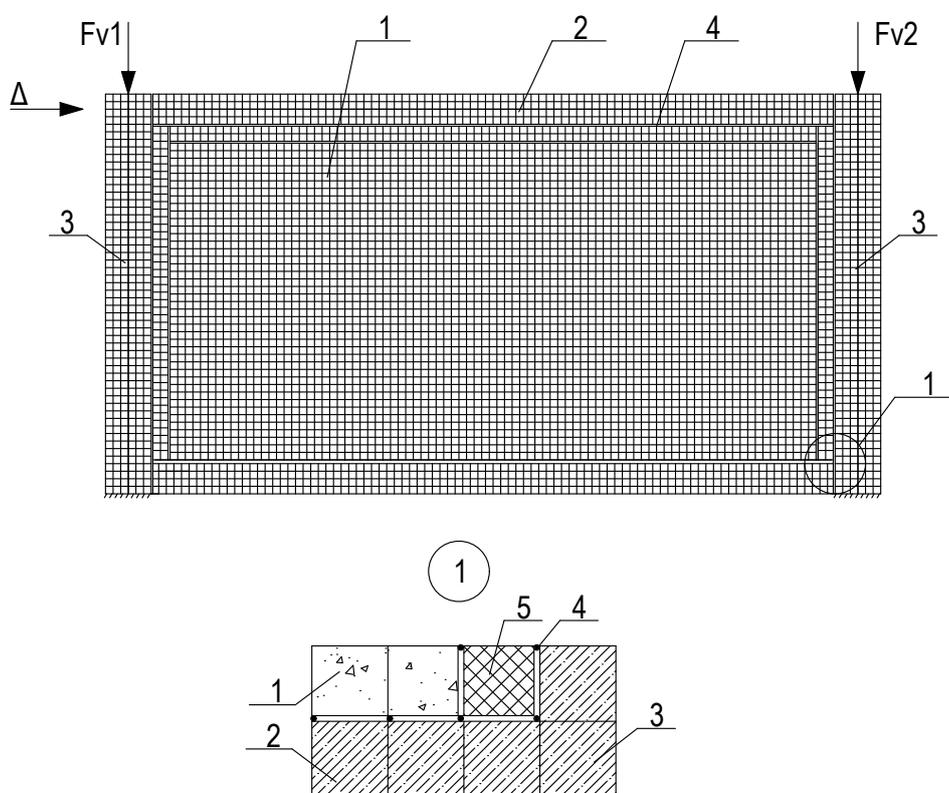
Податливое крепление элементов кладки стены к элементам каркаса:
